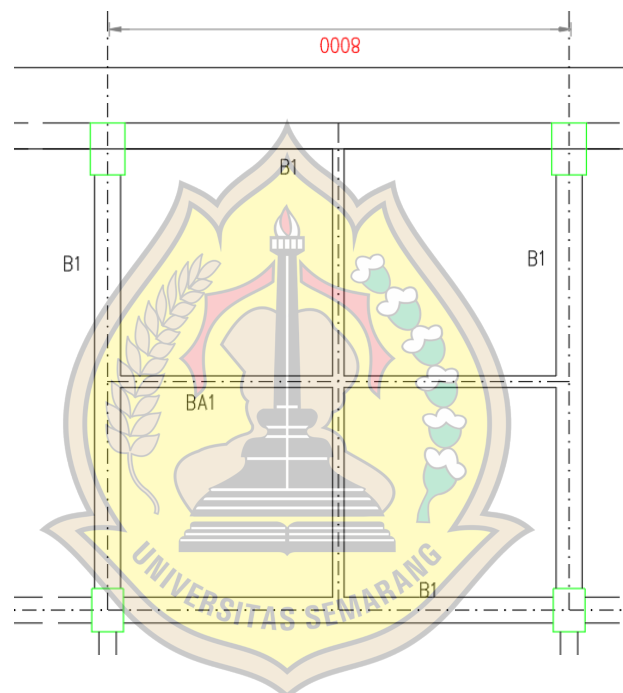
37 Pemodelan Gedung menggunakan Aplikasi SAP2000
